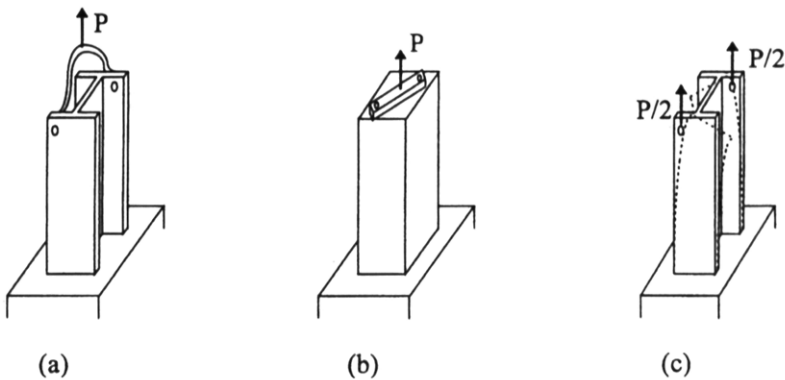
Influencia de la geometría de la sección en una barra sometida a tracción: a) perfil de pared delgada, b) sección llena, c) deformación en un perfil de pared delgada.
